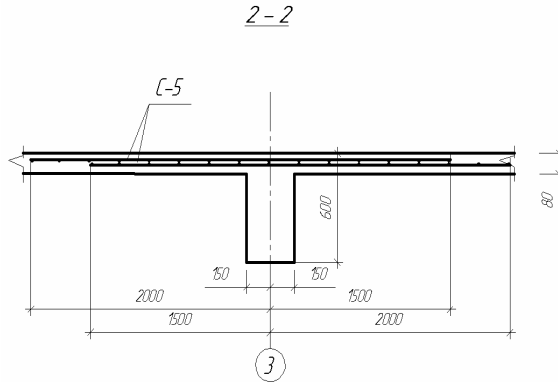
Армирование опорных зон второстепенной балки сварными сетками (арматура балок условно не показана)
